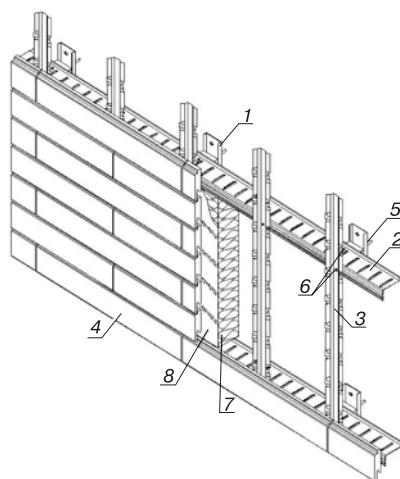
Схема конструкции навесной вентилируемой фасадной системы «Марморок»: 1 – консоль; 2 – горизонтальный профиль; 3 – вертикальный профиль; 4 – плита «Марморок» (тип «РВМ»); 5 – дюбель; 6 – саморез; 7 – штапельное стекловолокно ISOVER KL 37; 8 – ветро- и гидрозащитная мембрана типа Tyvek®
